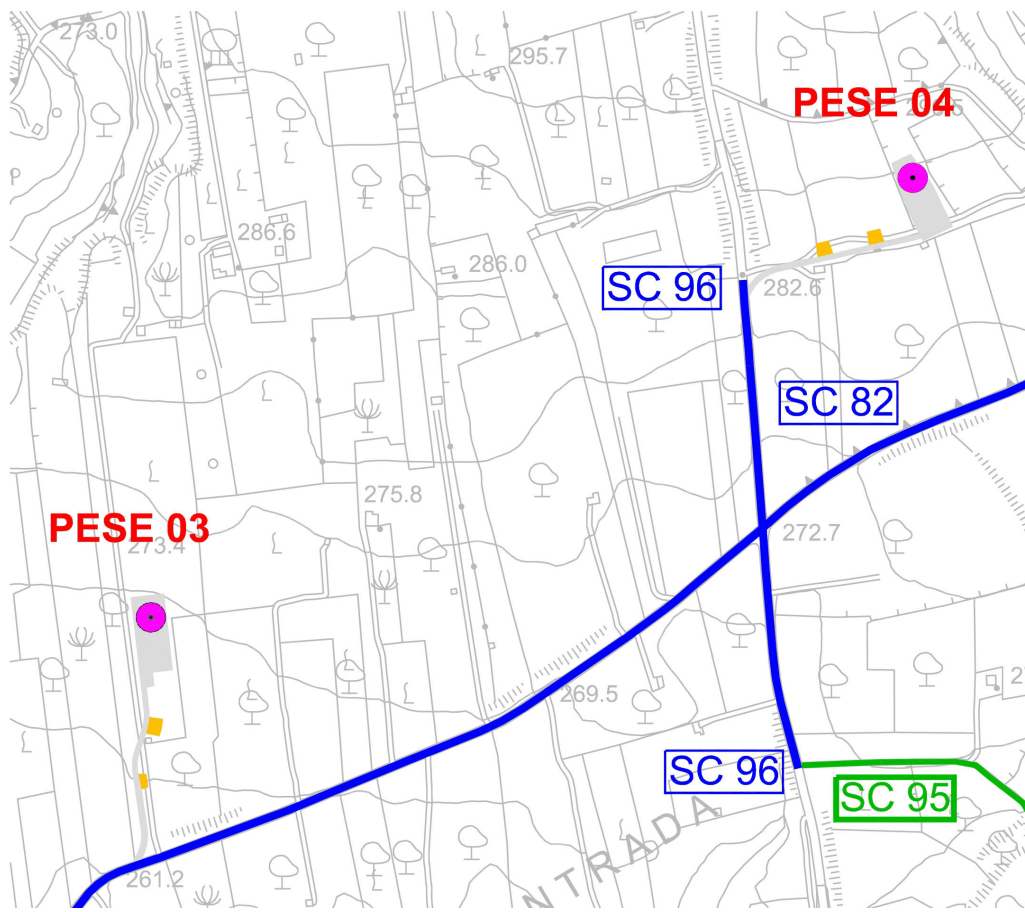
Planimetria delle strade di cantiere scala 1:5.000
